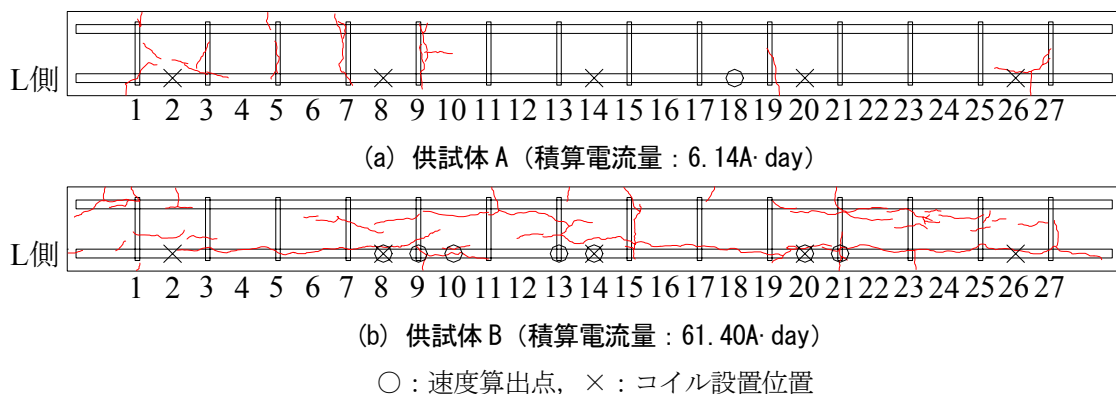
ひび割れ発生状況と超音波法および電磁パルス法での計測位置
